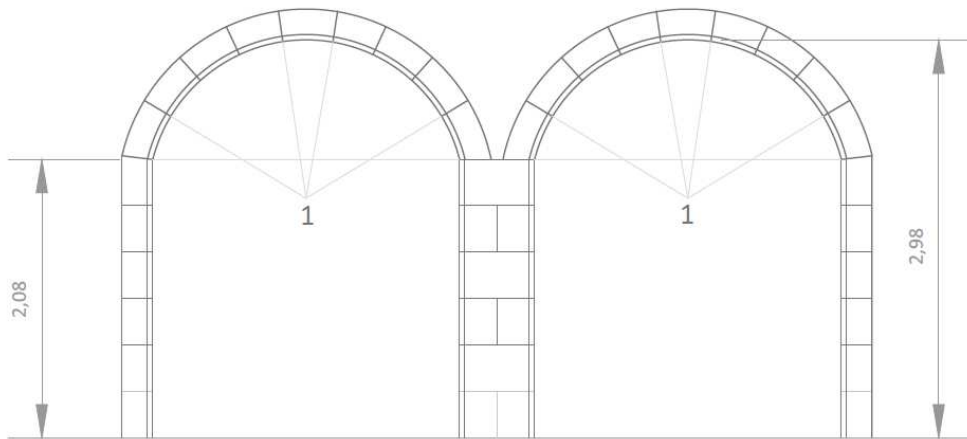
Esquema de arco rebajado situado en planta segunda. Elaboración propia
